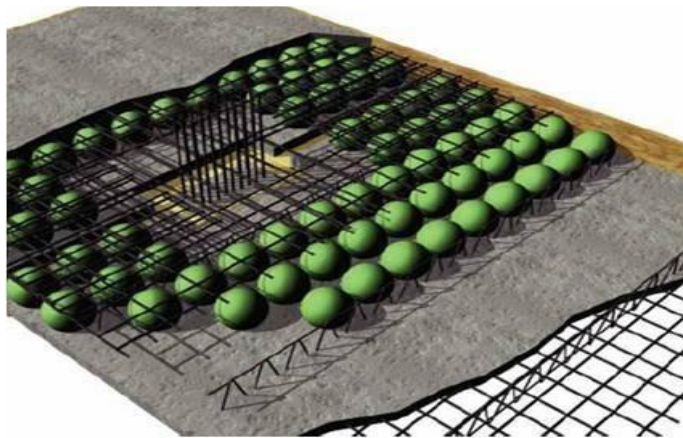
Esquema de componentes de Losa Bubbledeck. [5]
